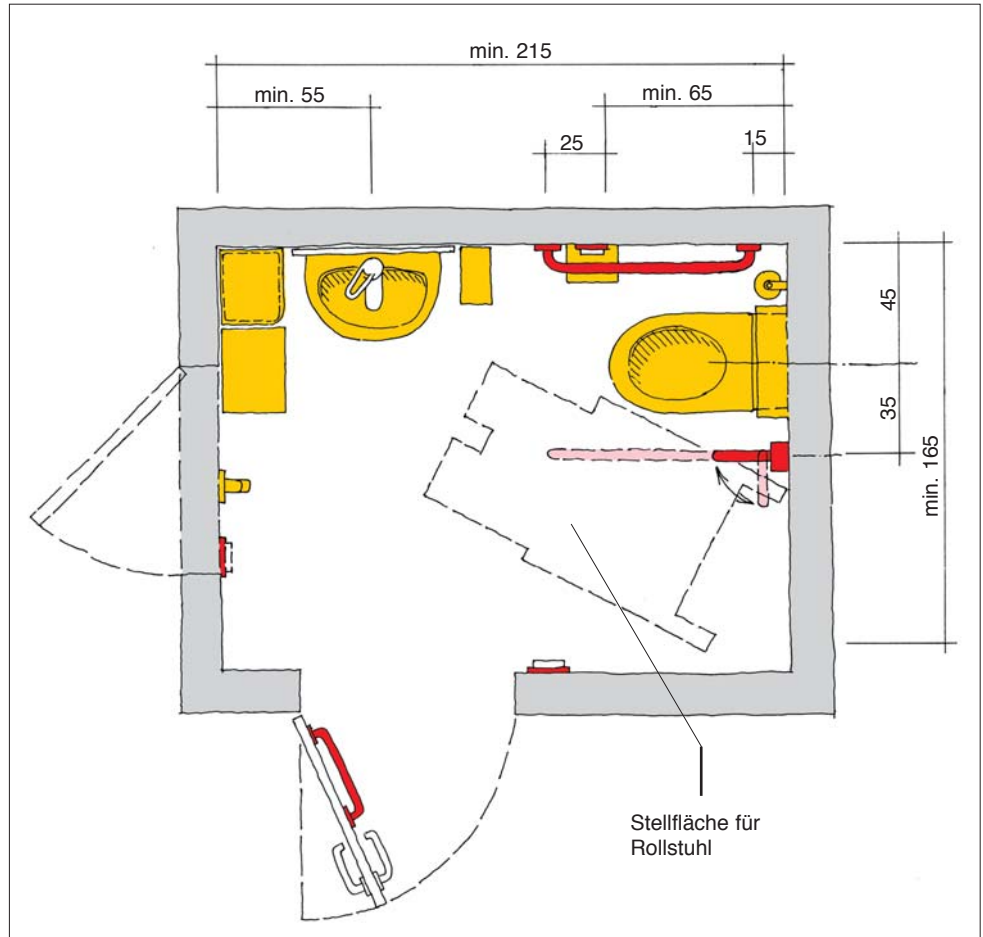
Grundriss zu Bild 1 (Mindestgröße nach ONÖRM B 1600)
